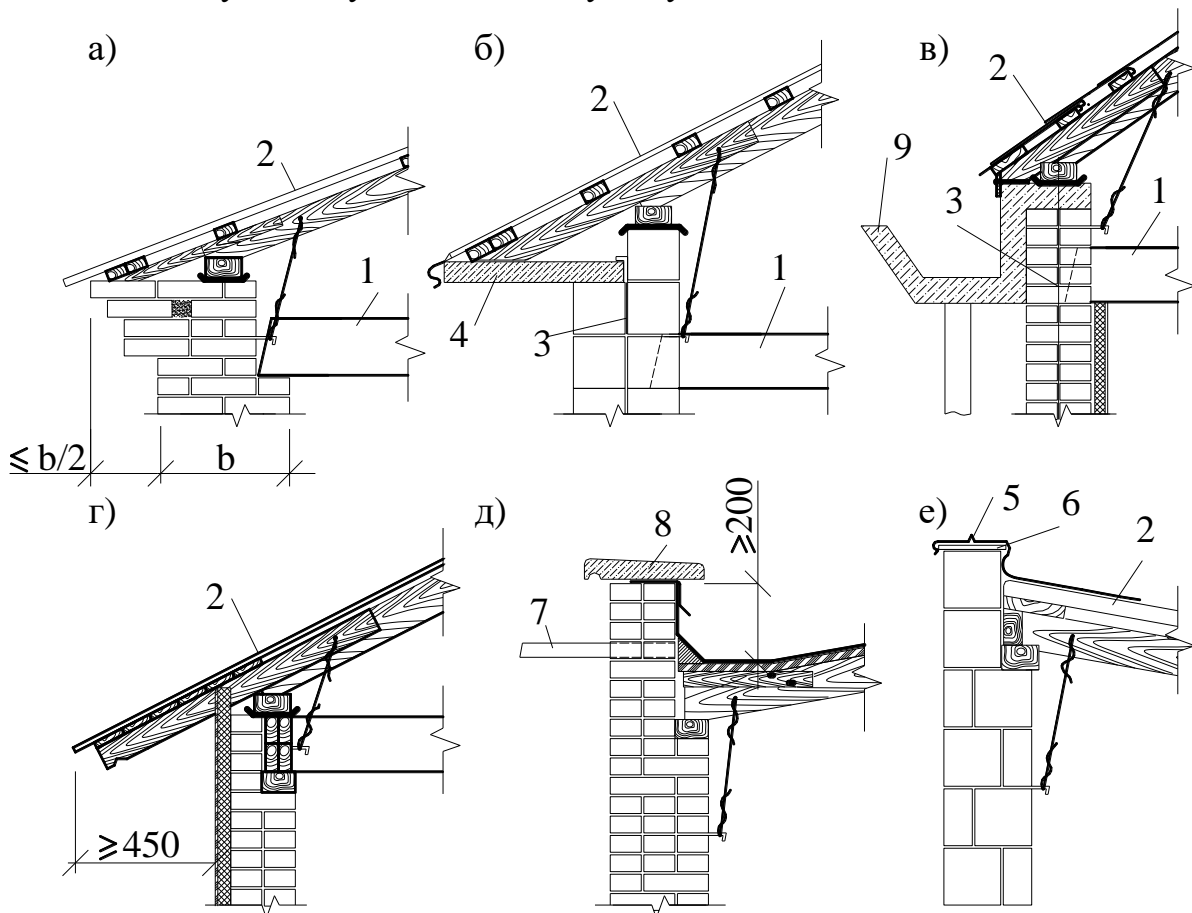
Вінець карнизи: а – з напуском цегли; б – із карнизною залізобетонною плитою; в – із залізобетонним лотком; г – із звисом покрівлі; д – парапет із консольними лотками водозбору; е – парапет зі зворотним стоком; 1 – перекриття; 2 – дах; 3 – сталевий анкер; 4 – залізобетонна плита; 5 – оцинковане залізо; 6 – сталеві полоси, прибиті дюбелями; 7 – лоток водозбору; 8 – бетонний парапетний камінь; 9 – залізобетонний лоток
